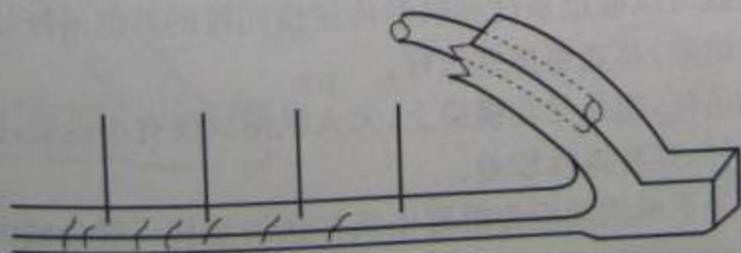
钢管系杆拱混凝土系杆上表面靠吊杆处横桥向开裂
